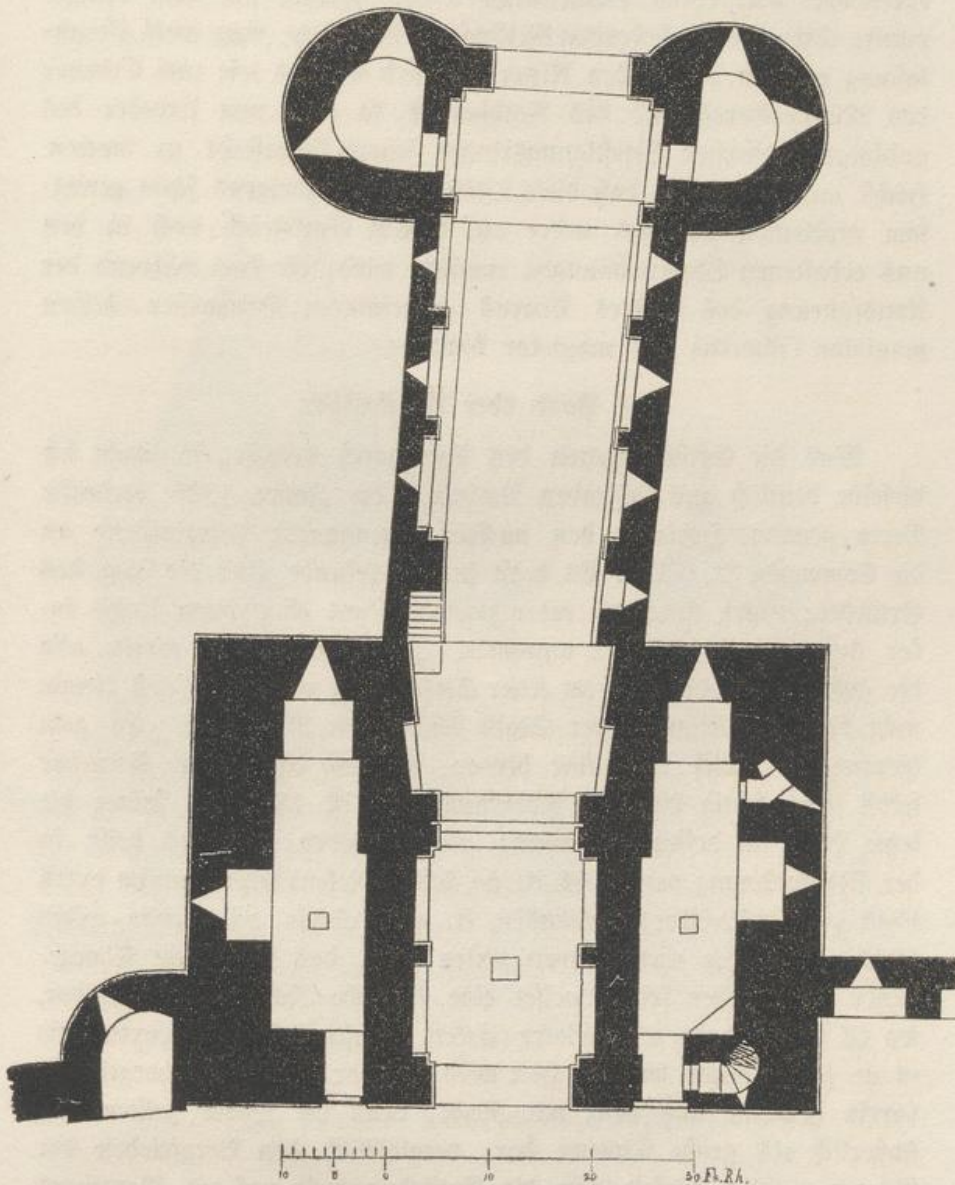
Grundriß des Aachener Pontthores zur ebenen Erde.
